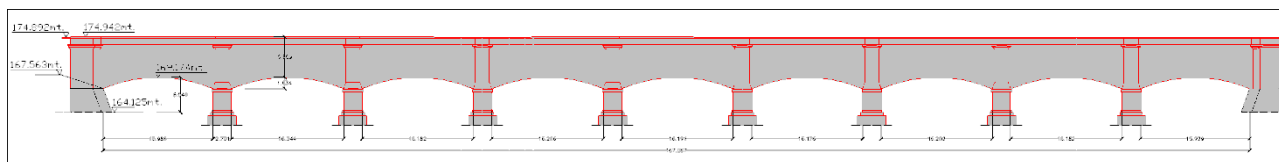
Prospetto di rilievo del ponte canale Cavour.
